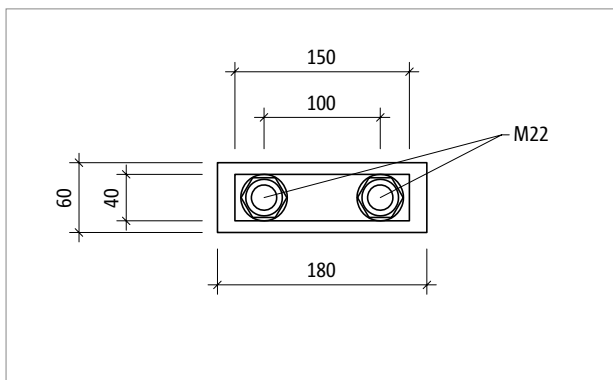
Schöck Isokorb® T typ S-N-D16: Řez prvkem
